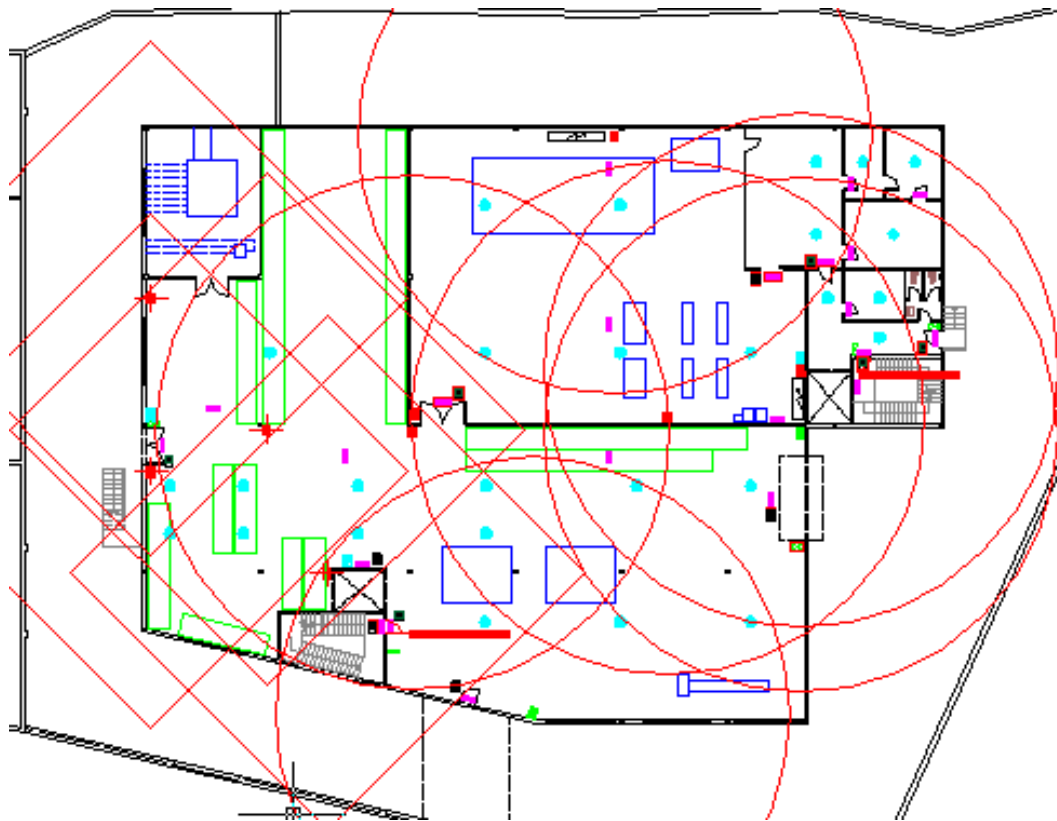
Superficie cubierta por los extintores en la planta baja del edificio Almacén
